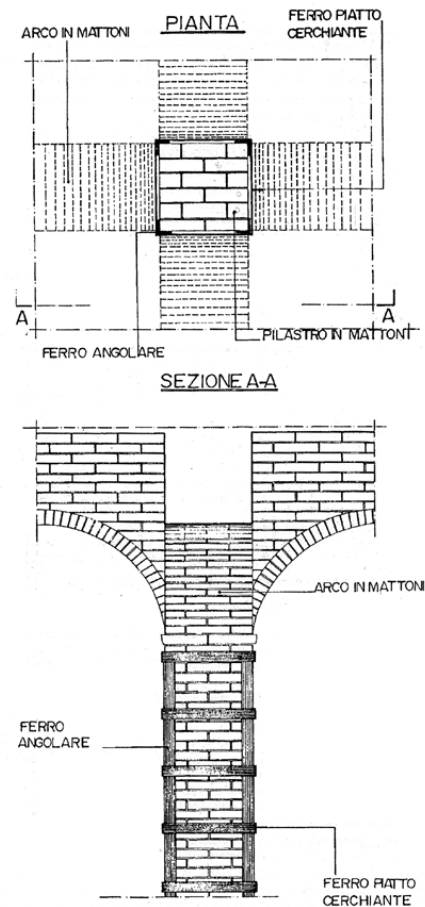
Cerchiatura di un pilastro murario (11).
